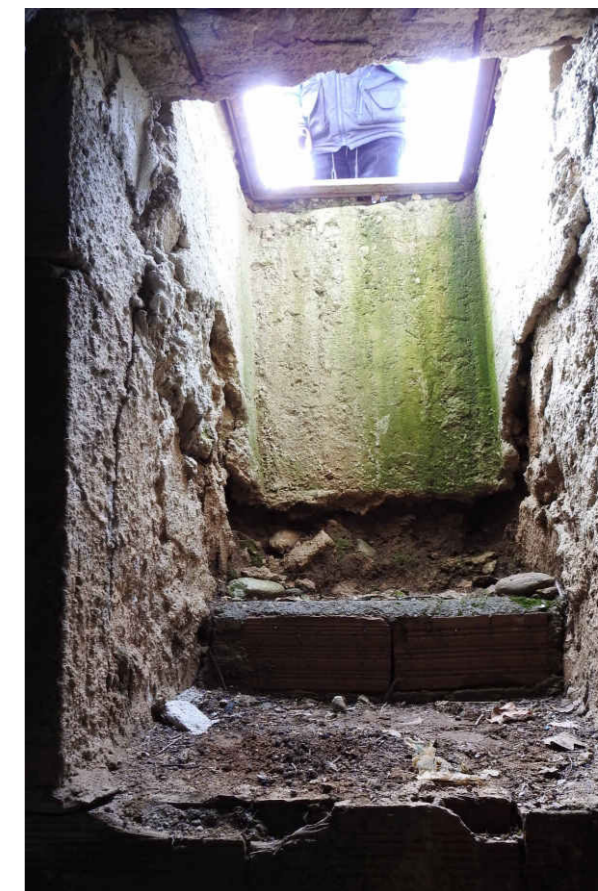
Il pozzetto di Foto N°5 visto dall'interno del vano fondale N°1
